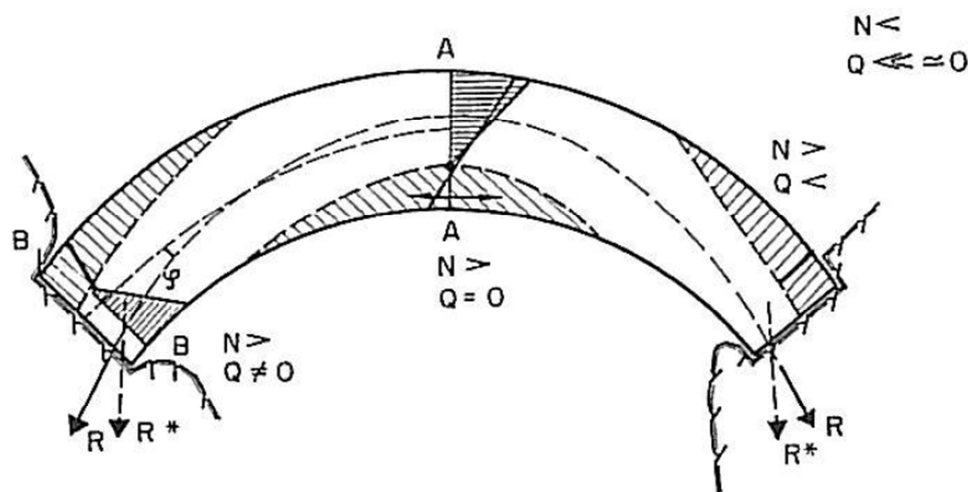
Sección horizontal de una presa bóveda con comportamiento mixto arco/viga.
